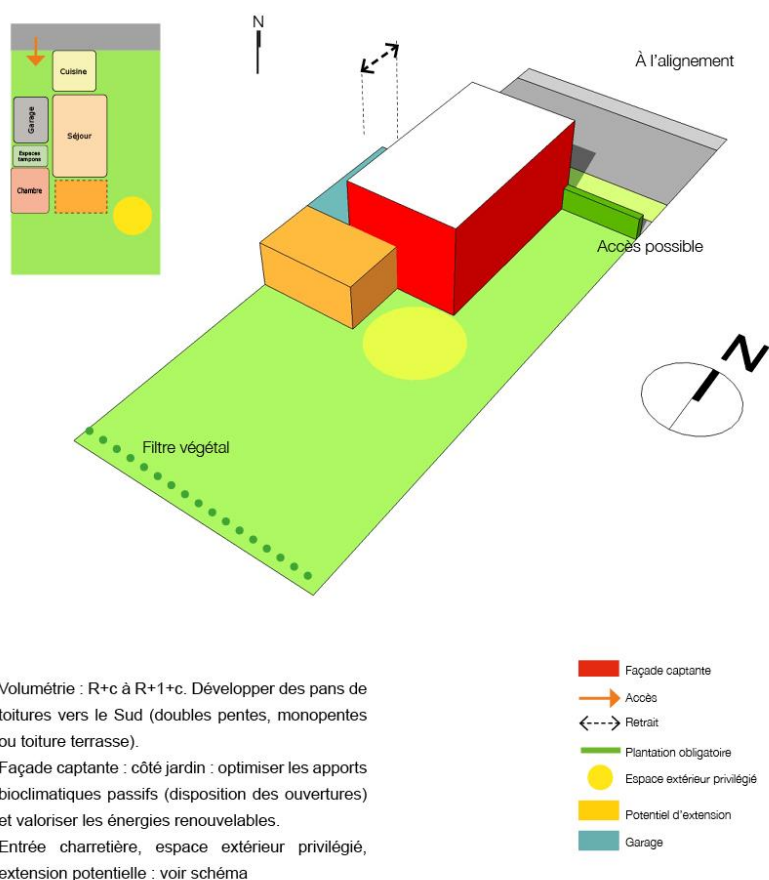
Exemple d'implantation d'un lot libre (Façade d'entrée Nord)
